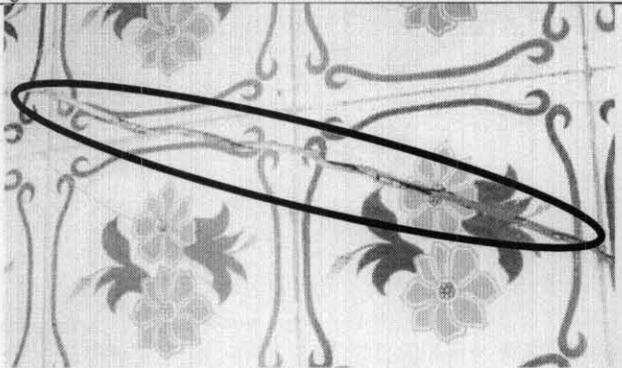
Agrietamiento en muros, predio Transversal 16F Bis B # 49A - 66 sur
